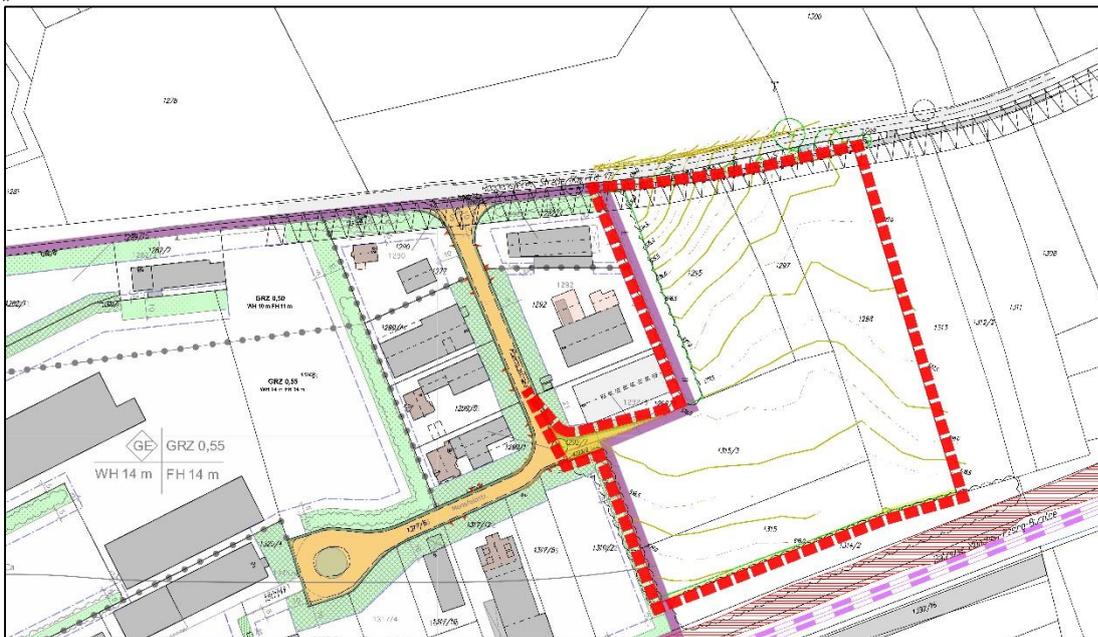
1. Änderung des Bebauungsplanes südlich Roggensteiner Straße
